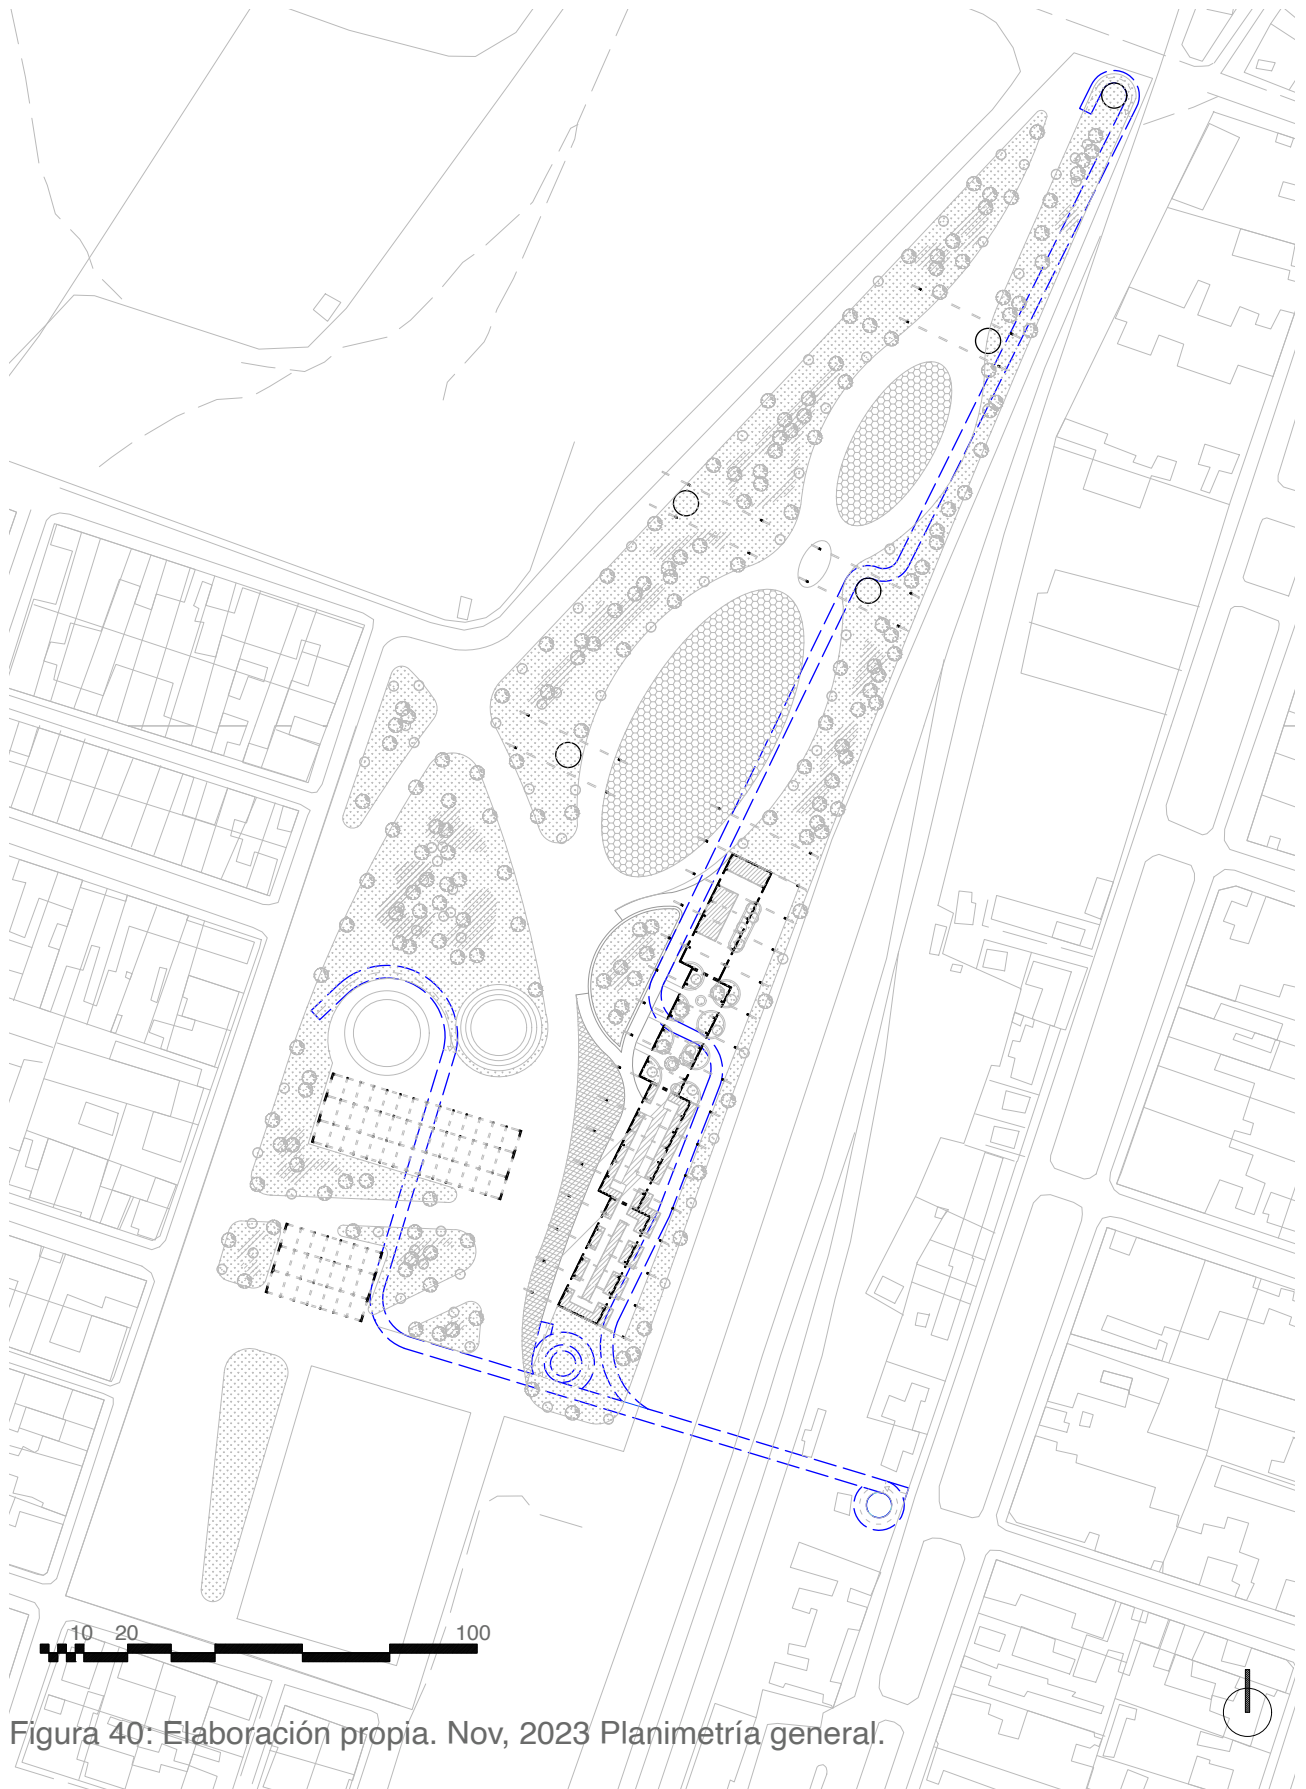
Elaboración propia. Nov, 2023 Planimetría general.
